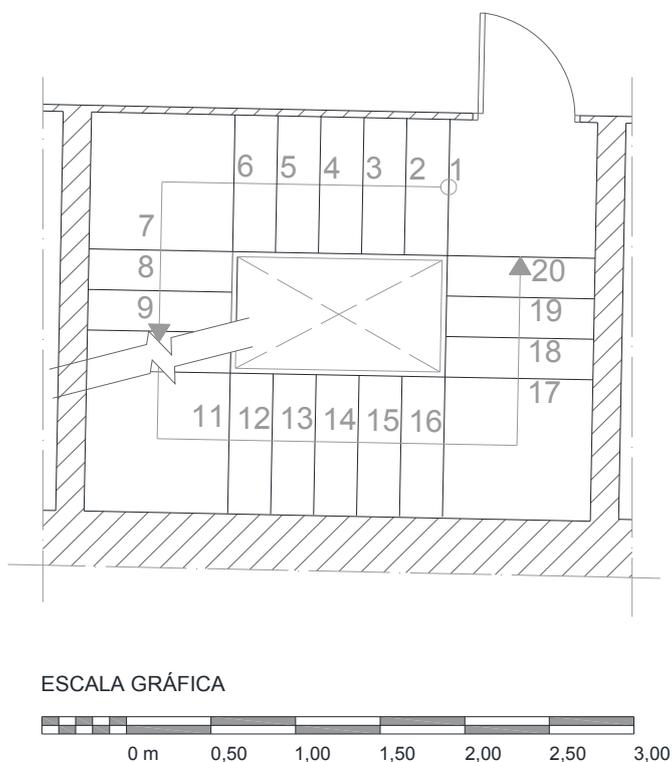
Distribución de la escalera en planta primera y segunda.
